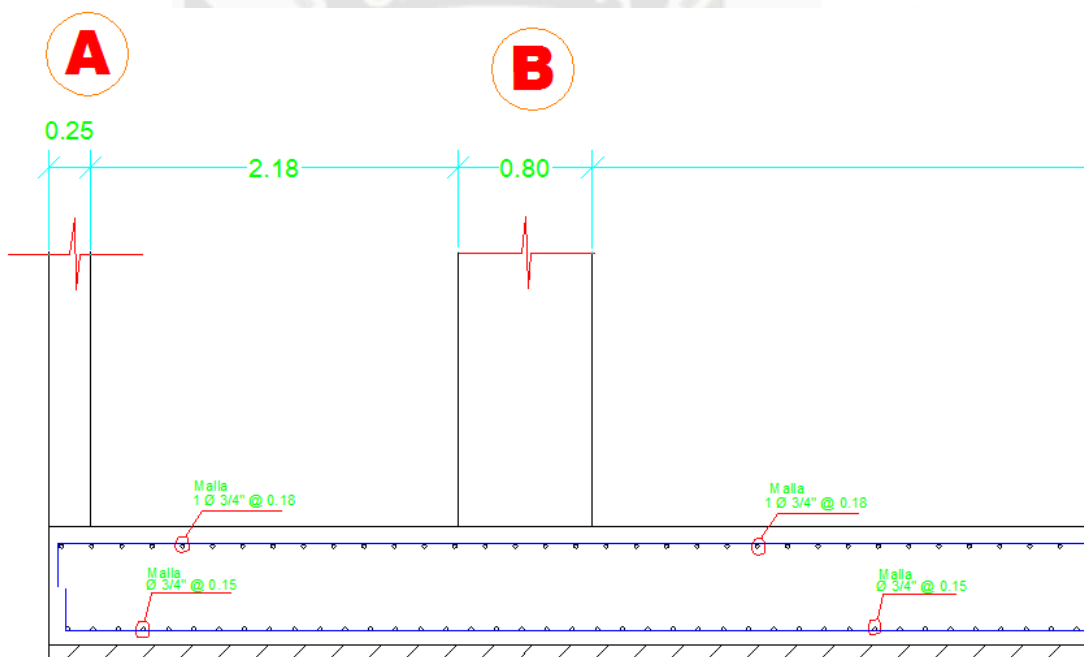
f. Diseño final Losa de cimentación
